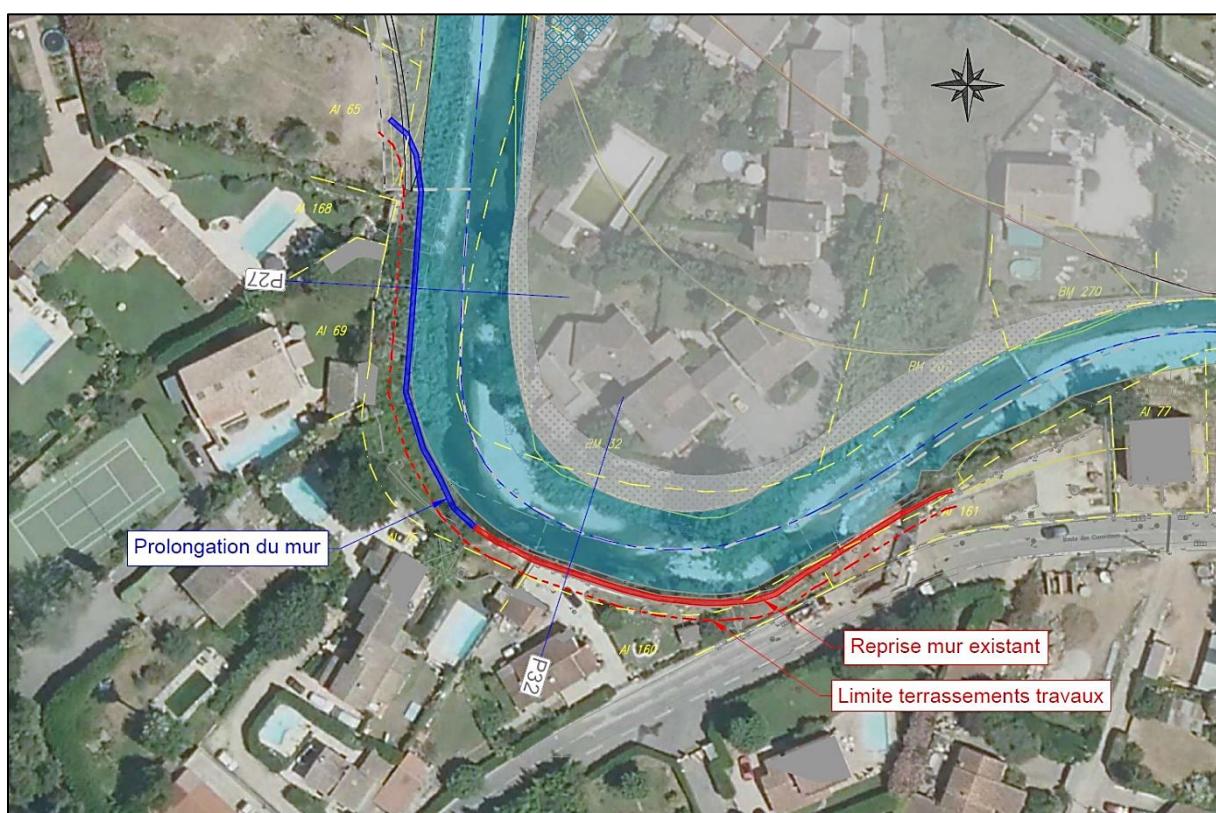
Plan masse des travaux de confortement de la berge rive droite
